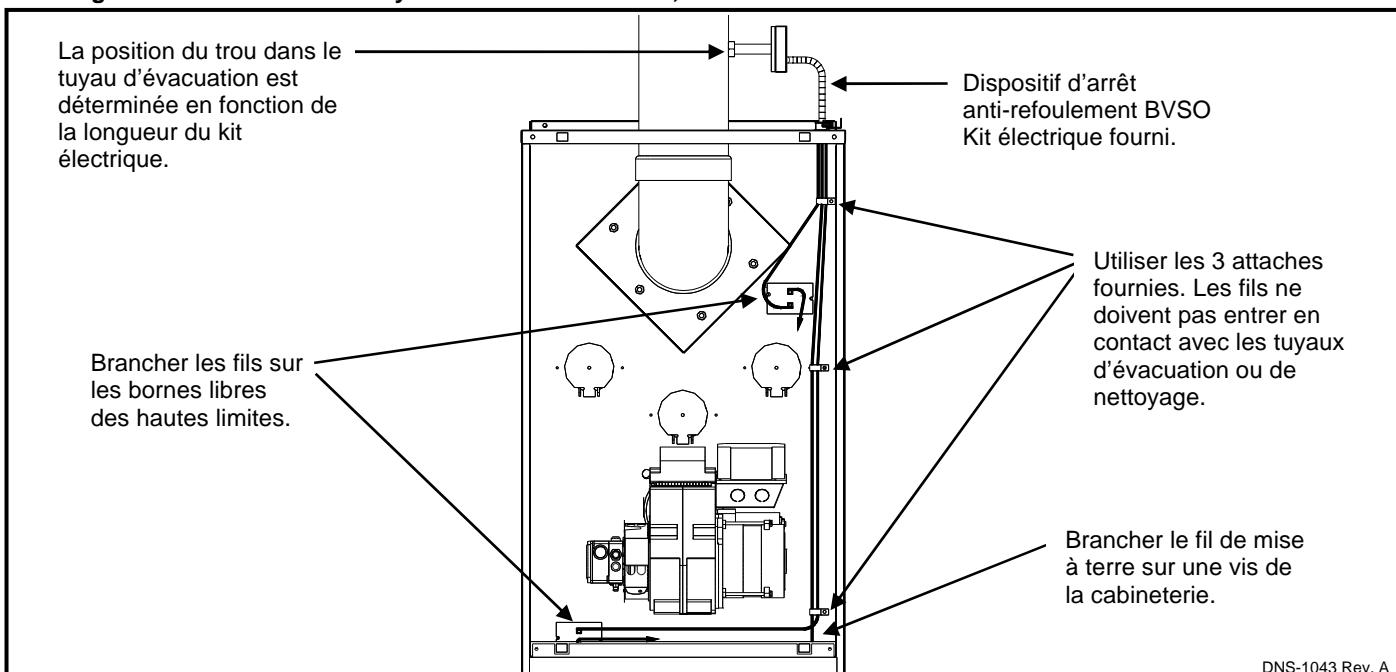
Branchement dispositif anti-refoulement, installation débit ascendant et évacuation verticale
